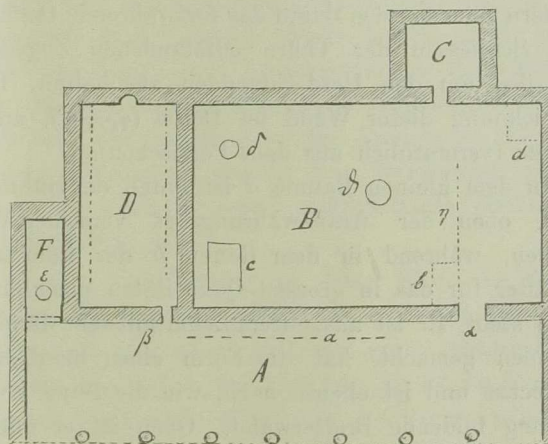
Grundriss eines Hauses im Dorfe Hghordi.
